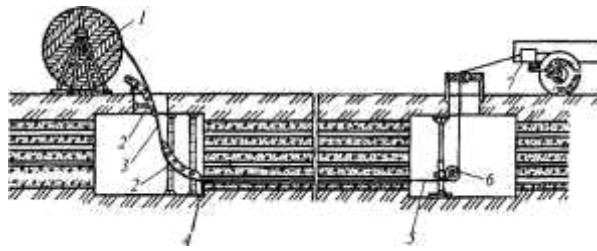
Схема протягування кабелю на одній ділянці: 1 — барабан з кабелем; 2 — кутовий ролик; 3 — кабель; 4 — роз'ємна воронка; 5 — канат; 6 — ролик для каната; 7 — пристрій для встановлення натягу
